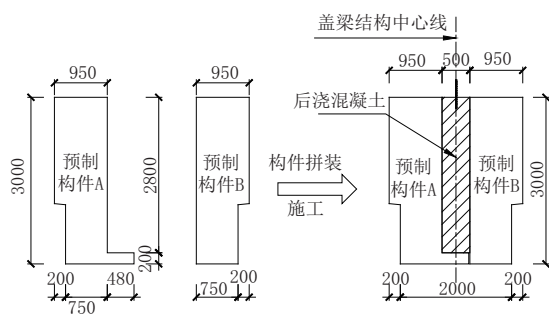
分片盖梁断面构造及拼接方案示意图(单位:mm)
